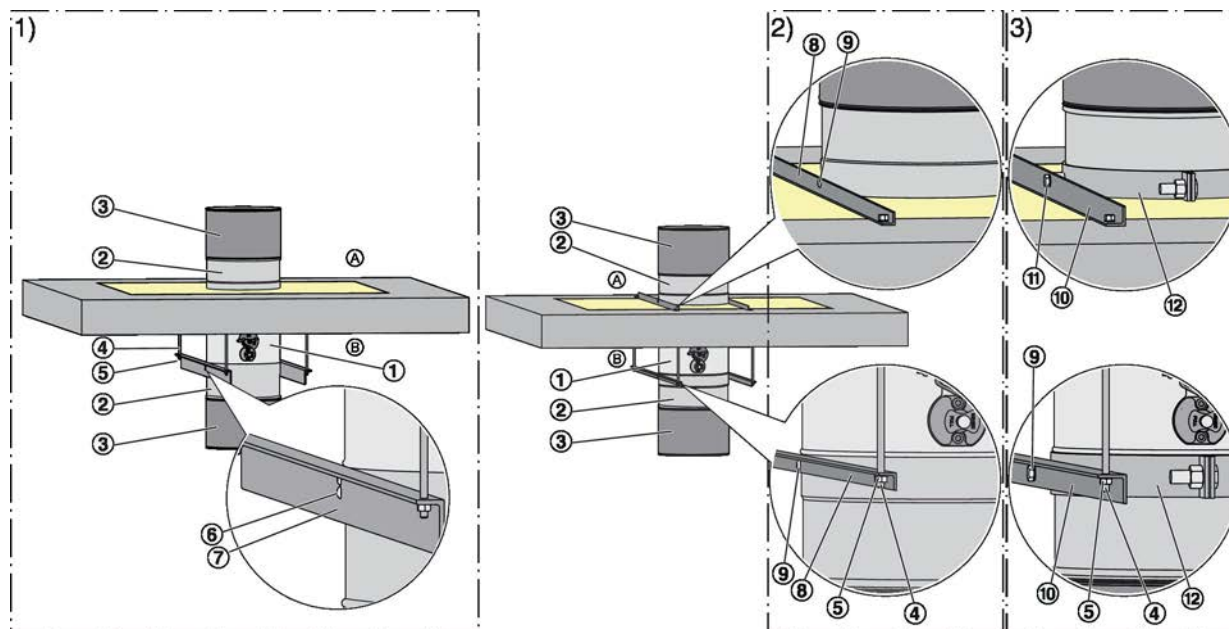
Variantes de montage suspendu pour clapets coupe-feu
